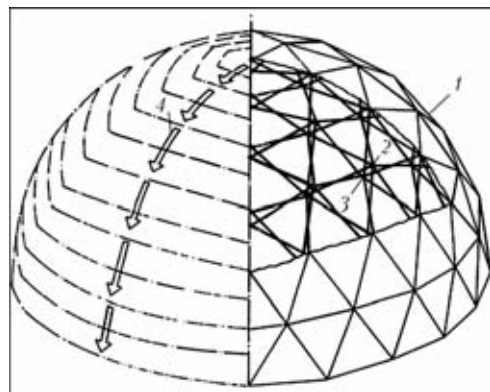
Схема складывающейся конструкции [10]: 1 — сферическая конструкция; 2, 3 — точки шарнирного закрепления; 4 — направление складывания
